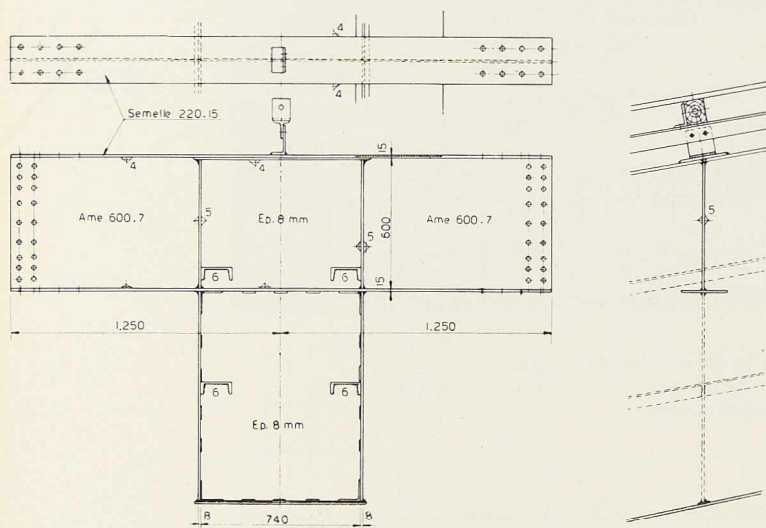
Détail de la section d'une maîtresse-poutre à l'endroit du passage d'une panne.
